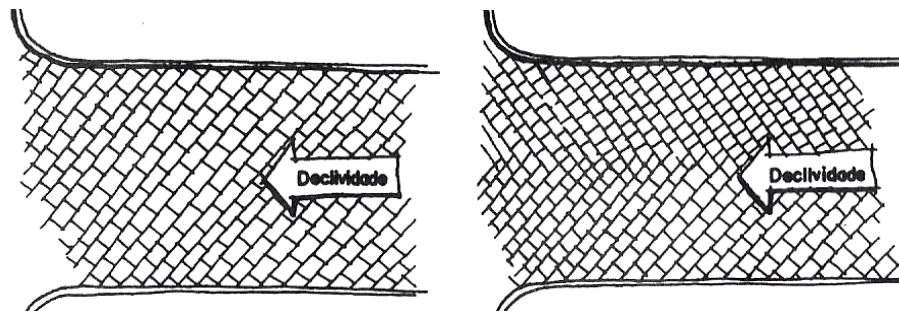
Pavimento de paralelepípedo ou blocos sem articulação colocados a 45° no sentido da via.
